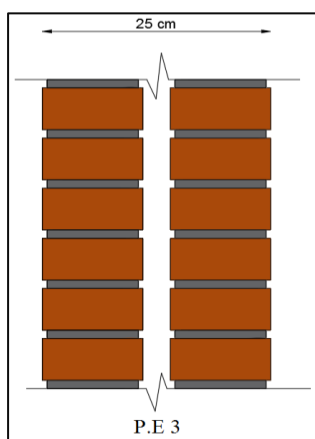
Corte da Parede Exterior 3 (P.E 3)
